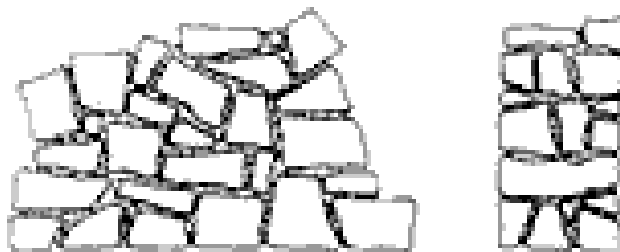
Esquema construtivo de parede de pedra com aparelhamento - Pedras angulosas dispostas irregularmente com uma face aparelhada
